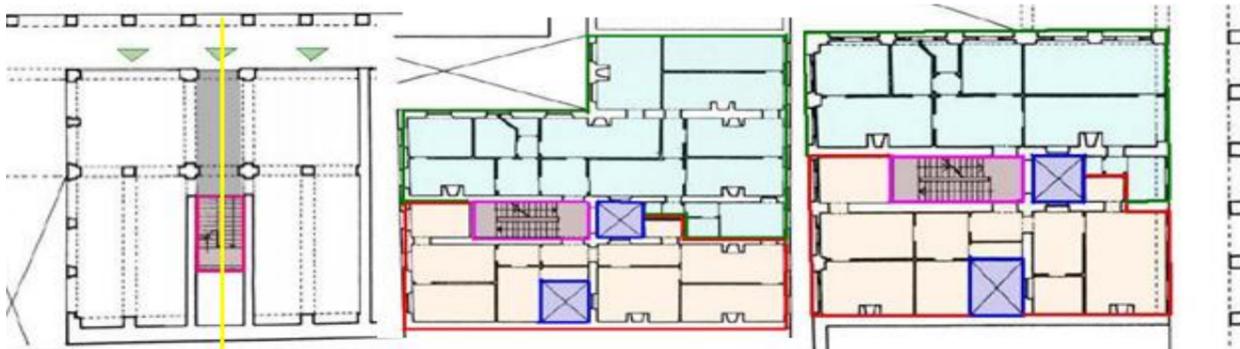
la façade d'un immeuble par rapport.
